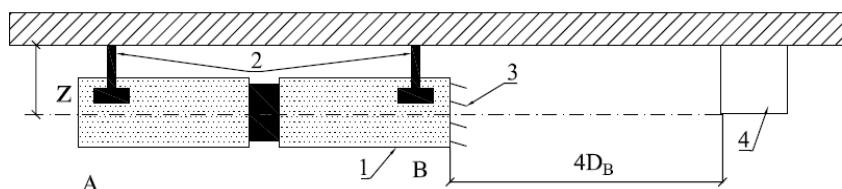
Схема установки струйного вентилятора. 1 – струйный вентилятор; 2 – анкерные болты; 3 – направляющий аппарат; 4 – потолочная балка; D_B – диаметр корпуса
